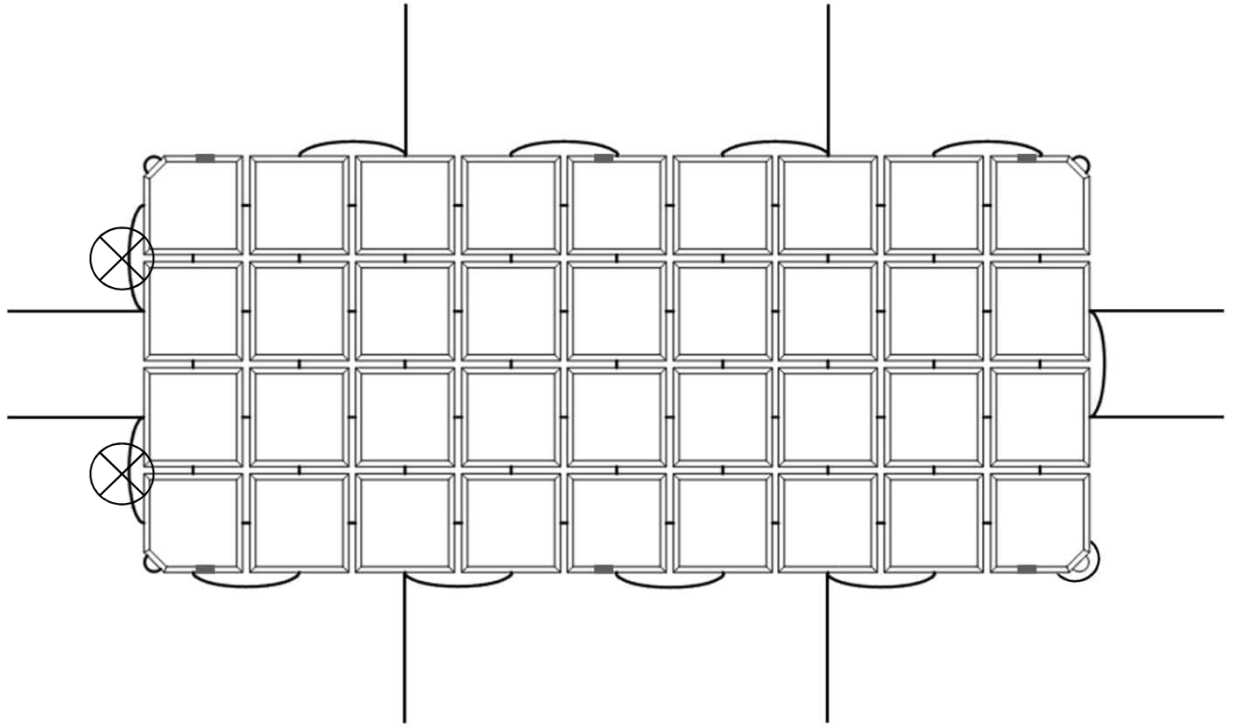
Места строповки гибкой бетонной плиты за две петли
